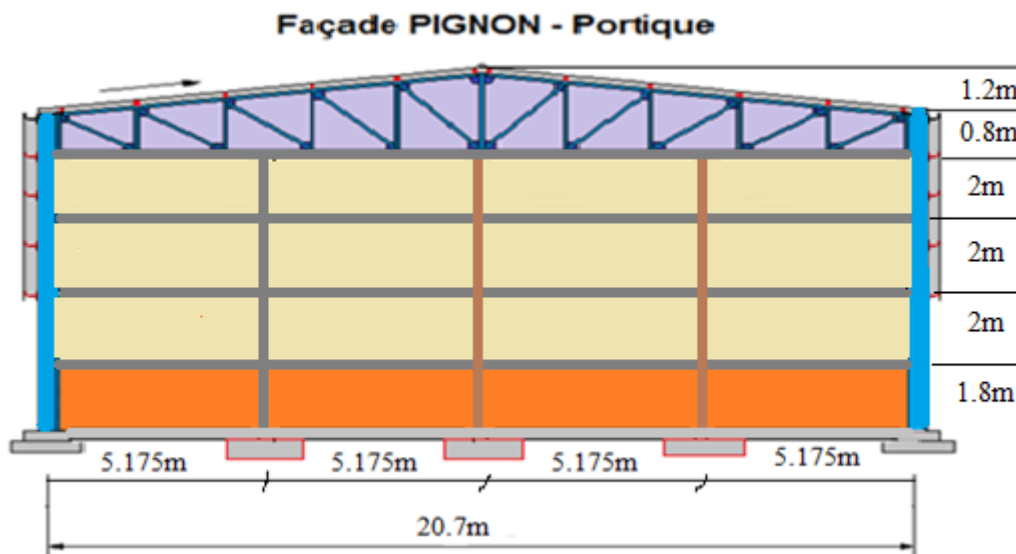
Coupe longitudinale de la lisse de bardage au pignon.
